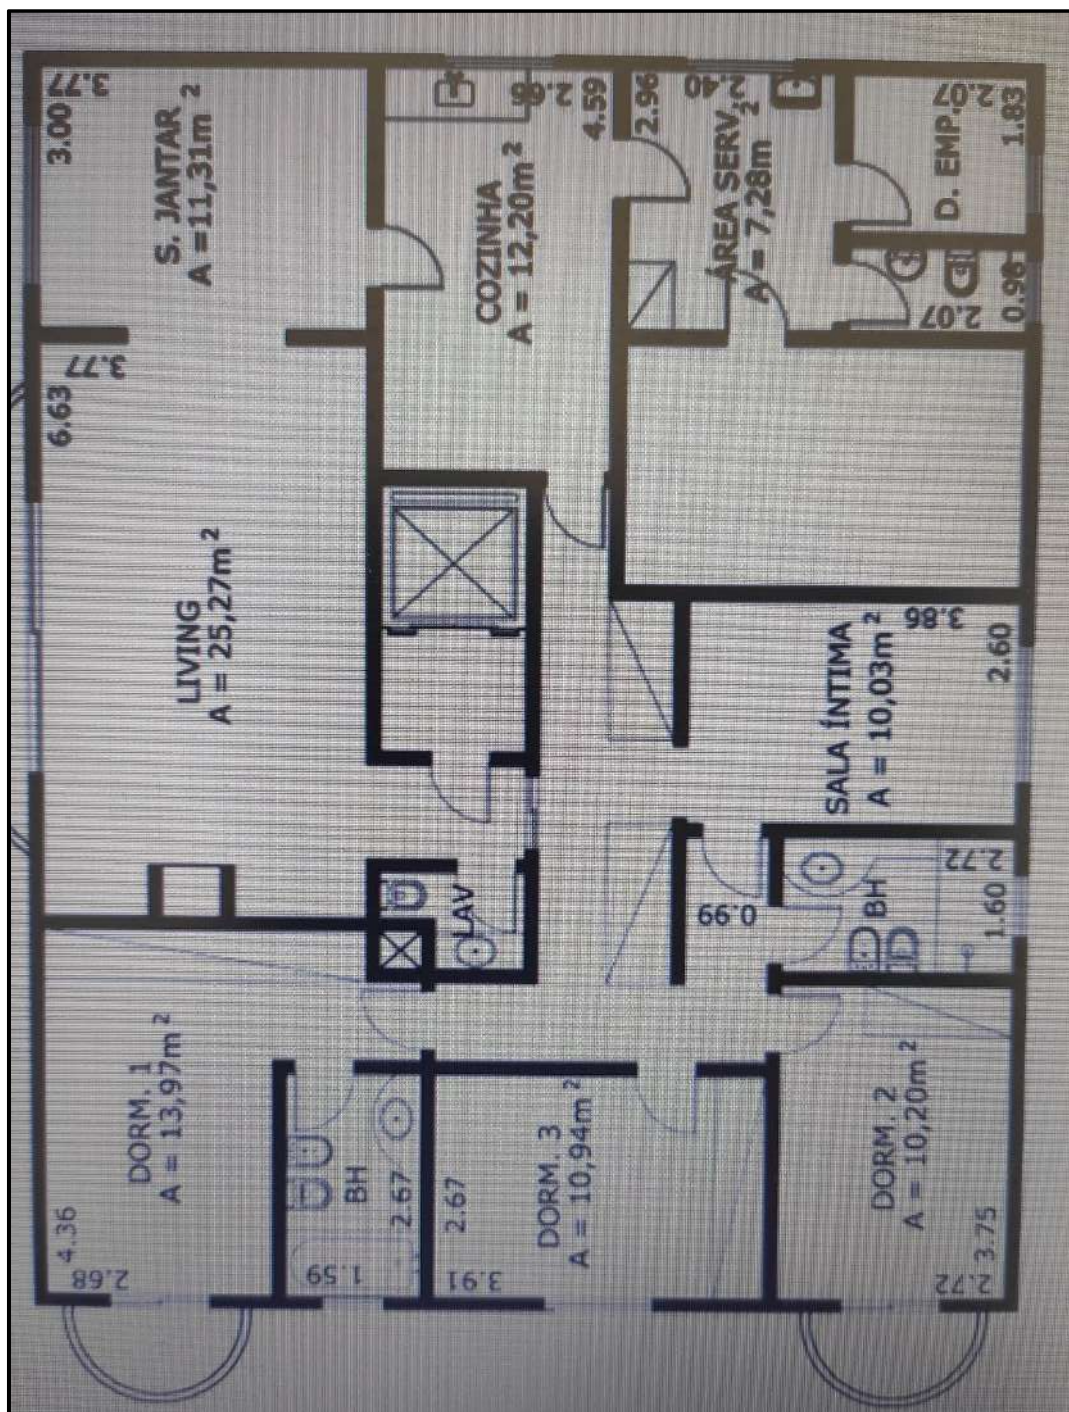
Planta do imóvel avaliando de número 81 conforme projeto construtivo
